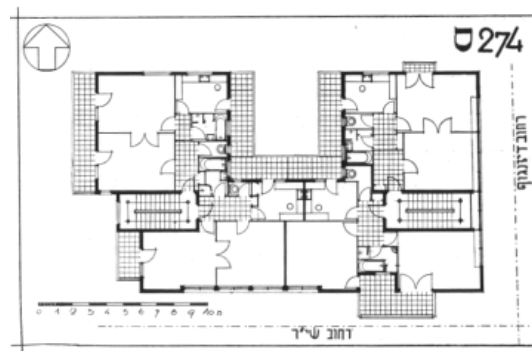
Arie Sharon. Planta baja de las viviendas para obreros H. 1937.
